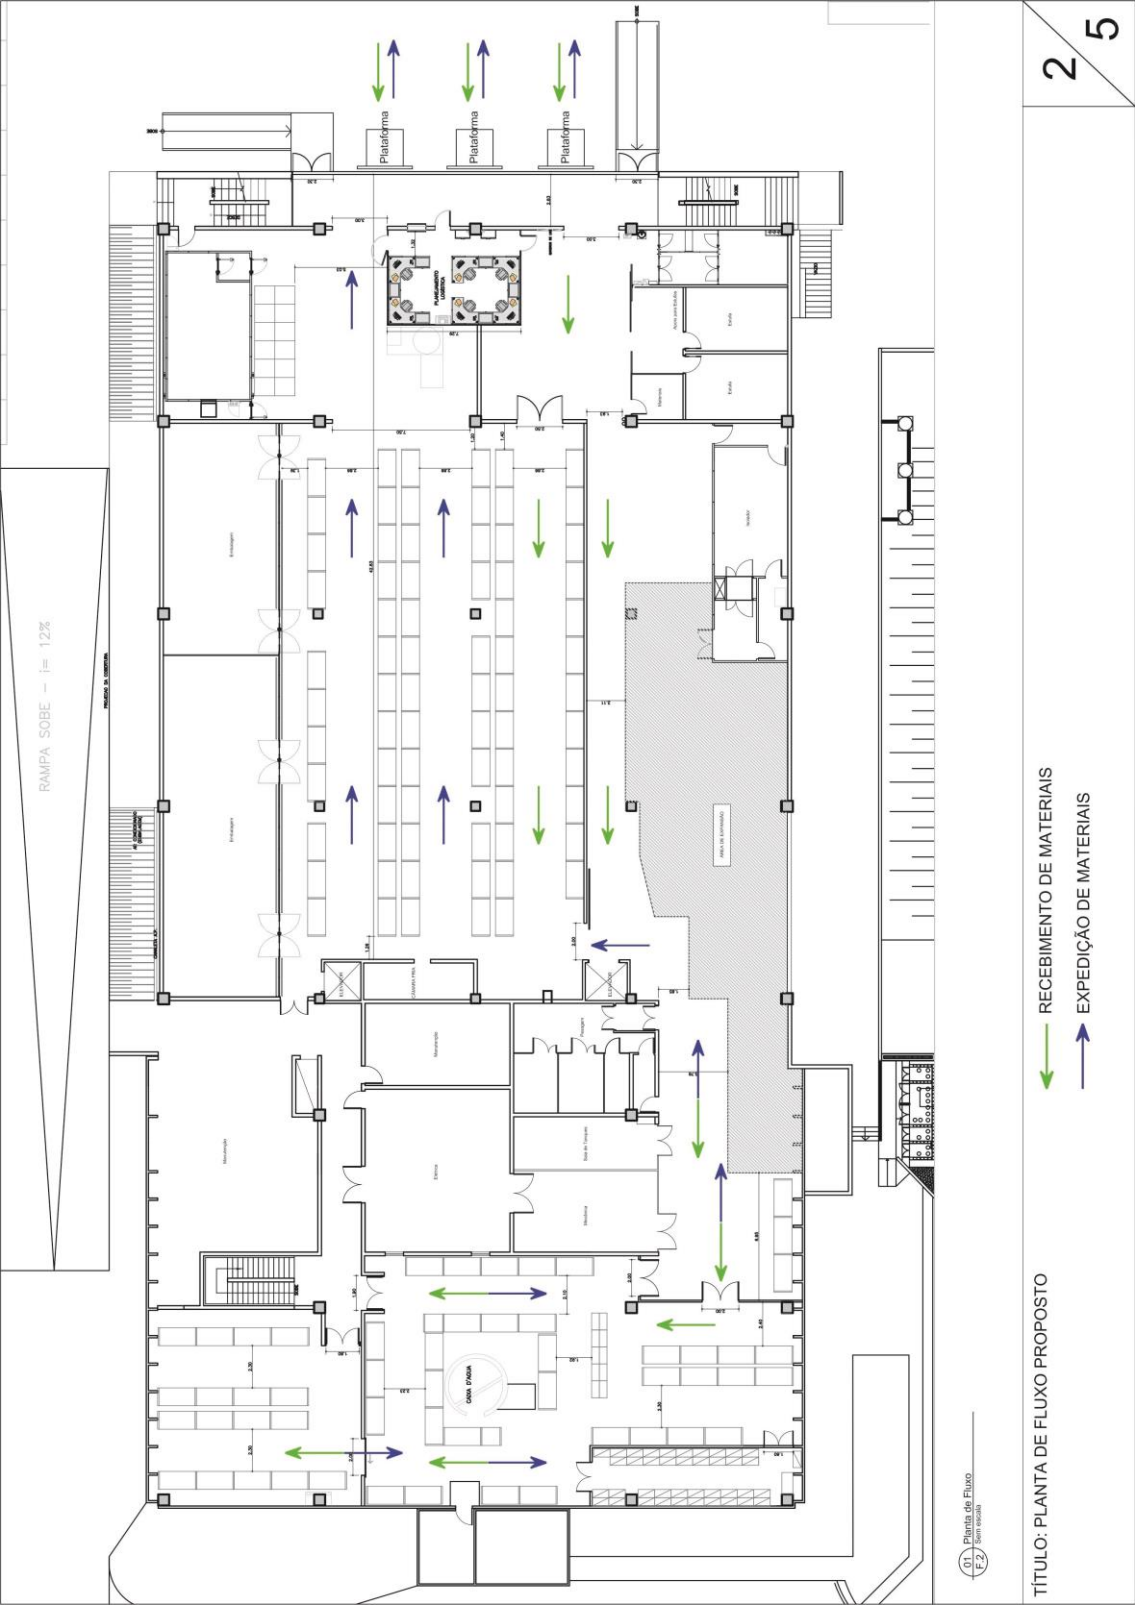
Planta de fluxo proposto, São Paulo – SP.
